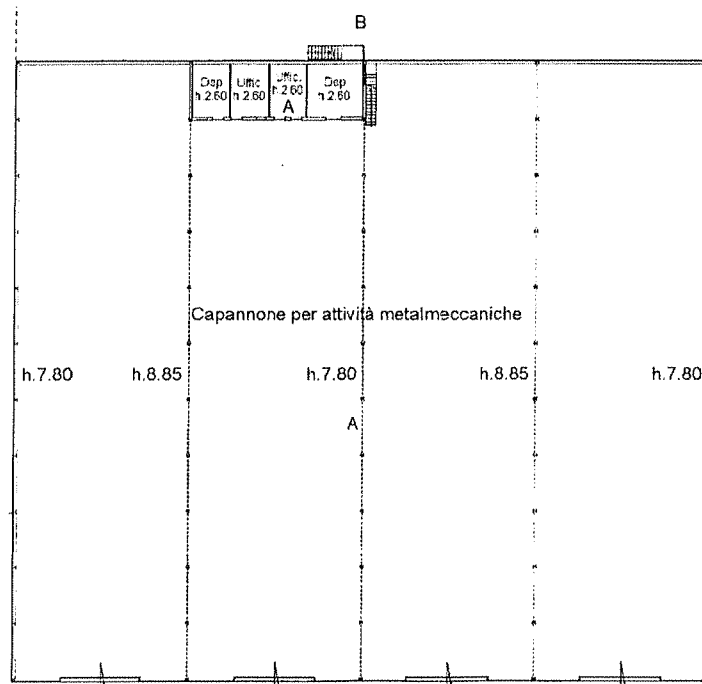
Planimetria dello stato attuale, conforme alla planimetria catastale (cfr. all. 4)
